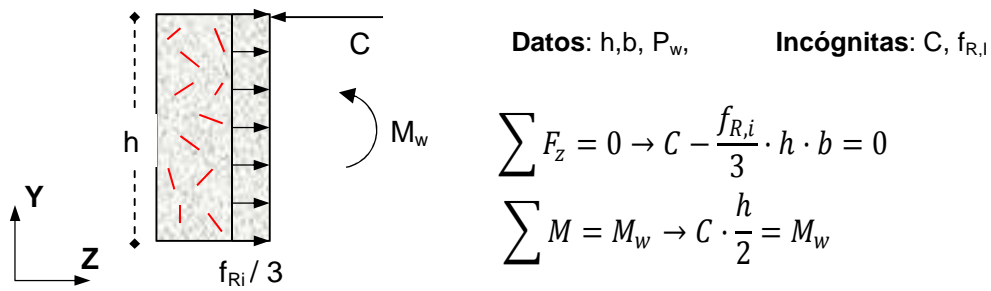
Cálculo seccional del HRF, en estado fisurado
